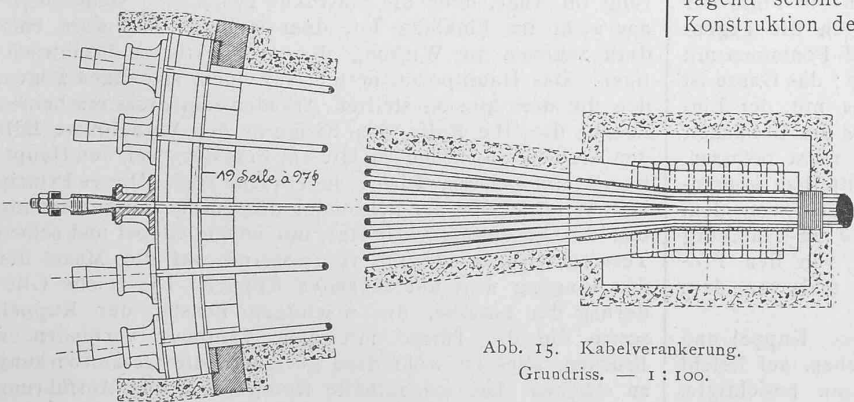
Kabelverankerung. Grundriss. — 1:100.
